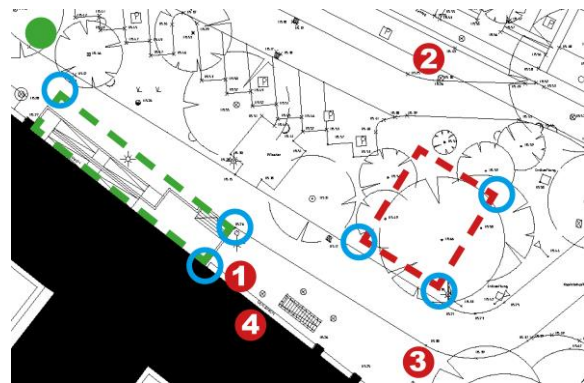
Vermesseralageplan mit Testgebäuden, Lichtmarkerpositionen (blau) und Teststandorten (rot: „FZK Haus“, grün: fiktive Glasüberdachung) (Planquelle: Vermessung und Bau Baden-Württemberg, Amt Karlsruhe)
